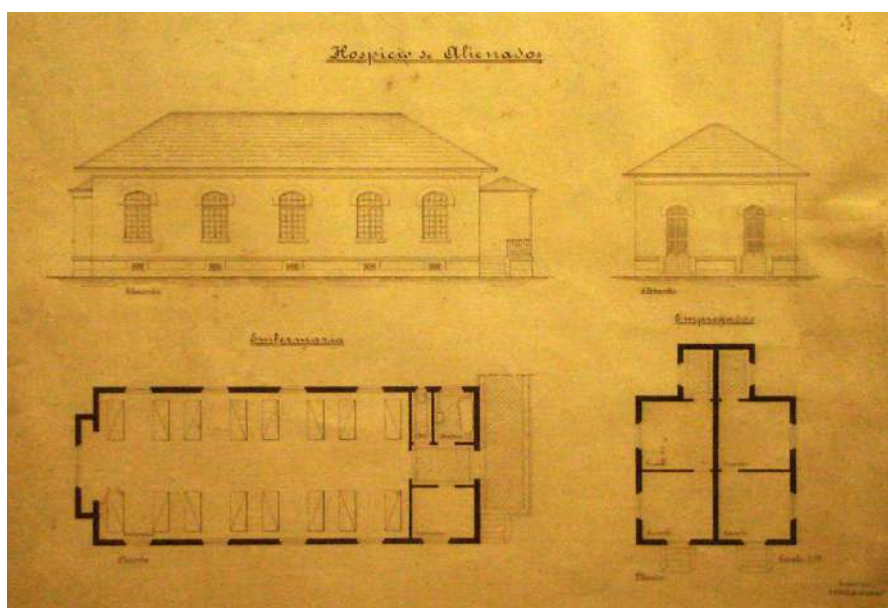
Plantas e Fachadas dos pavilhões de enfermaria e apoio de funcionários (acervo do Museu Osório César);
